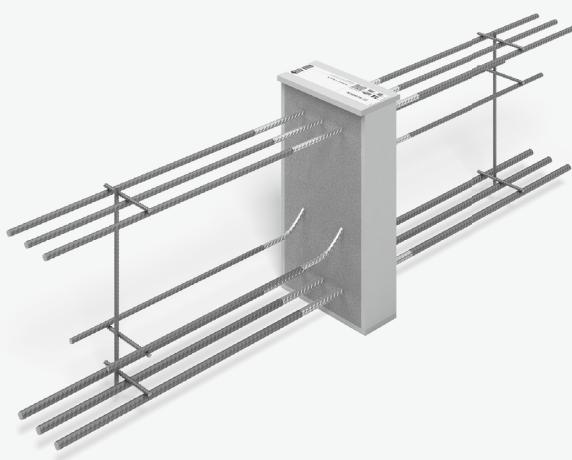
Schöck Isokorb® T tip DP: strop iz elementov s postavljenimi Isokorb® T tip DP
